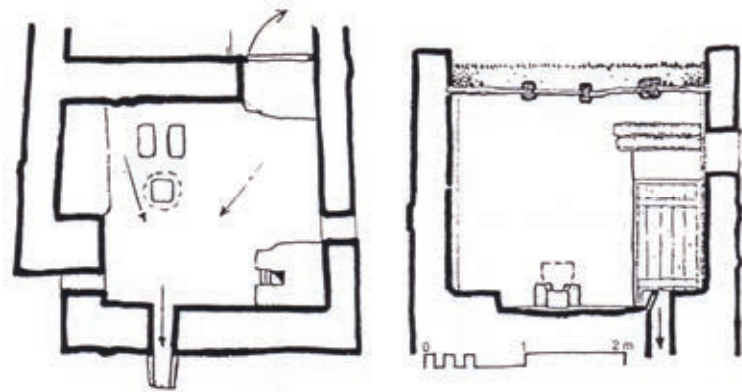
Grundriss und Vertikalschnitt einer typischen Toilette.
